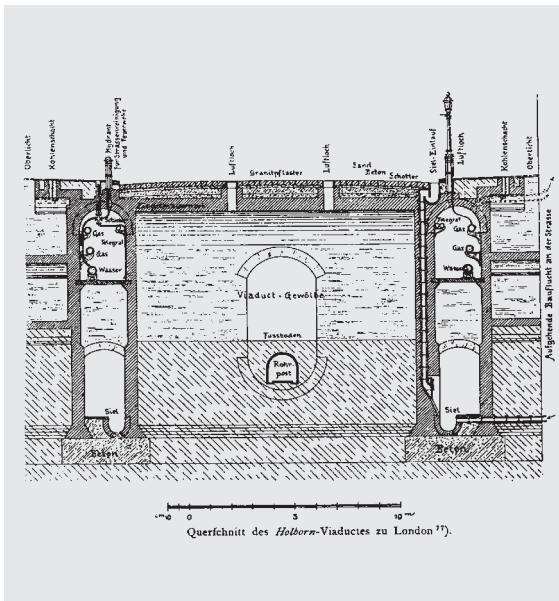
Sección de calle con canalización de torrente y galerías de servicios. J. Stubben (1890)
